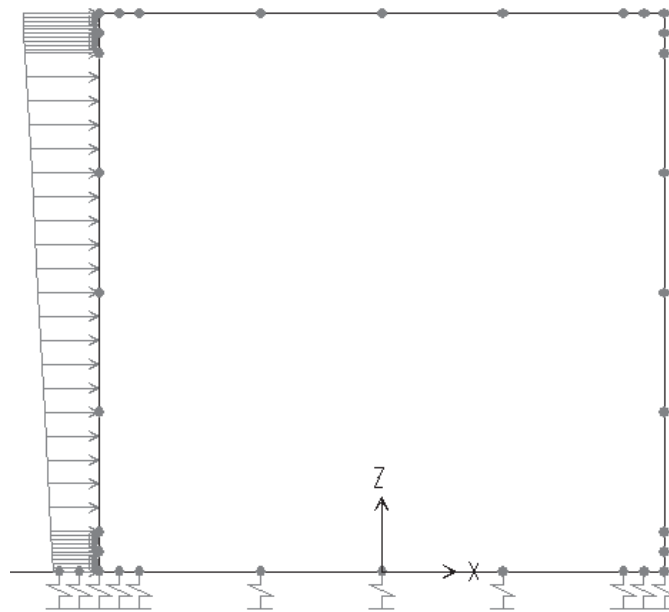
SPINTA DOVUTA DALL’AZIONE VERTICALE DA TRAFFICO SUL PIEDR. SX SQMS
